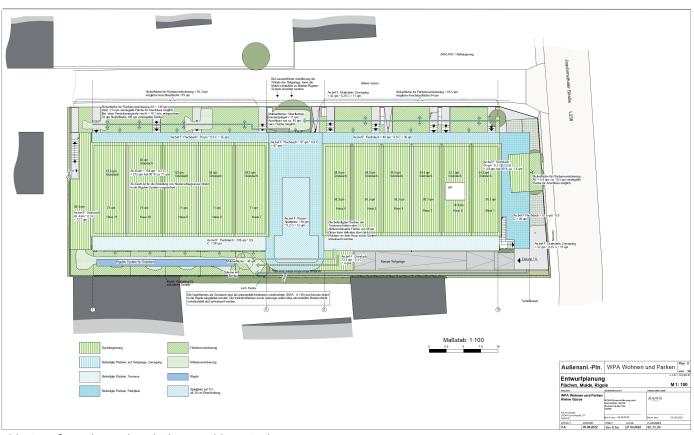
Außenanlagenplan Flächen. Mulden, Rigole
